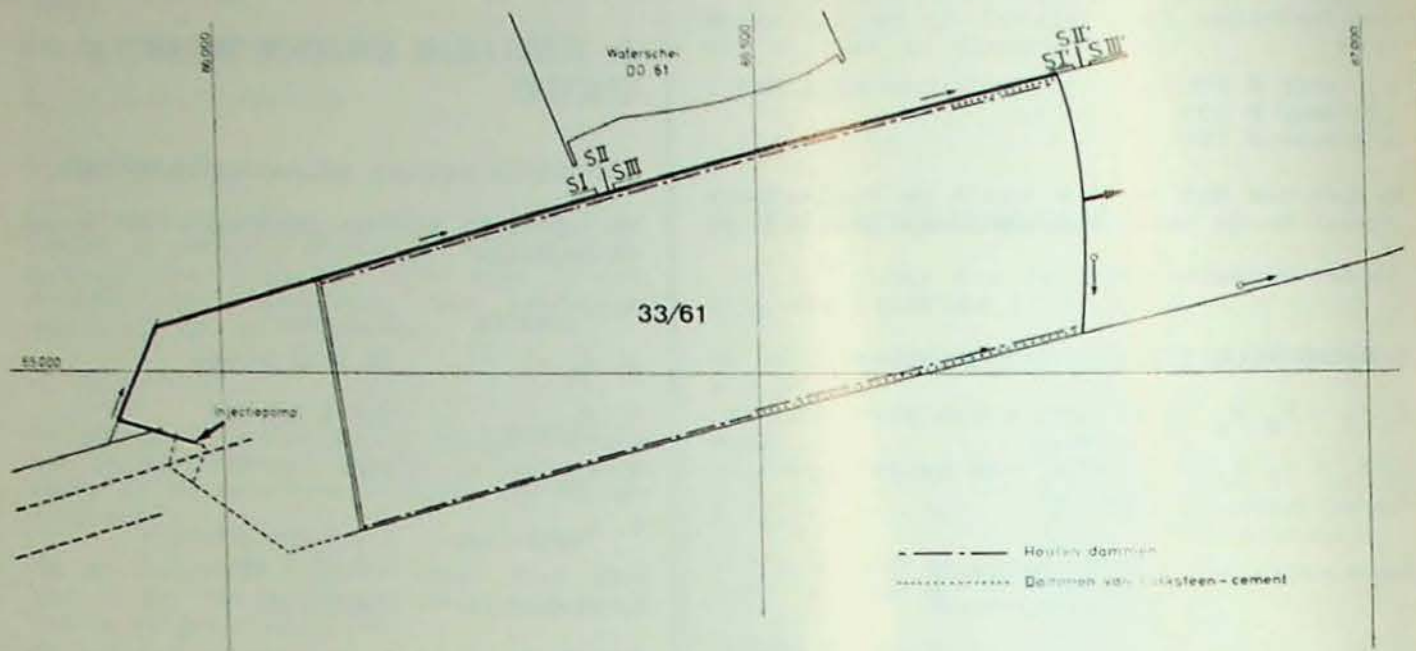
Liggingsplan van de secties voor convergentiemetingen in pijler 336.
